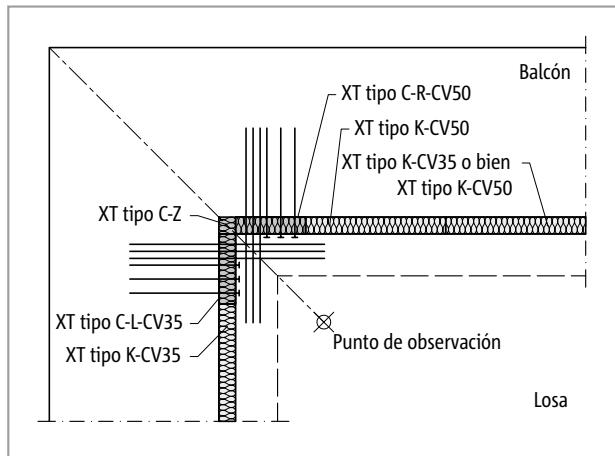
Schöck Isokorb® XT tipo C: Balcón en voladizo con esquinero externo (utilización de XT tipo C-L-CV35, XT tipo C-R-CV50)
